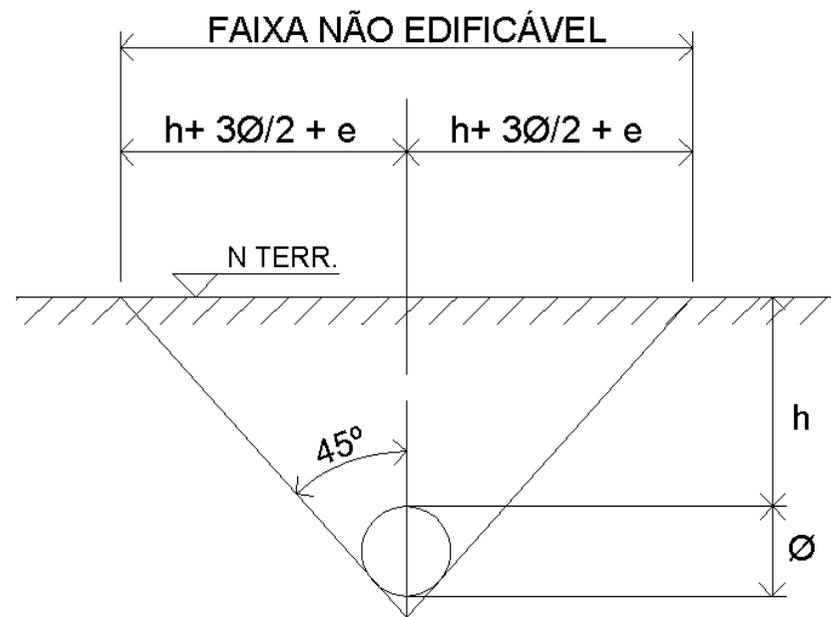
Faixa não-edificável gerada por canalizações pluviais de seção circular.
